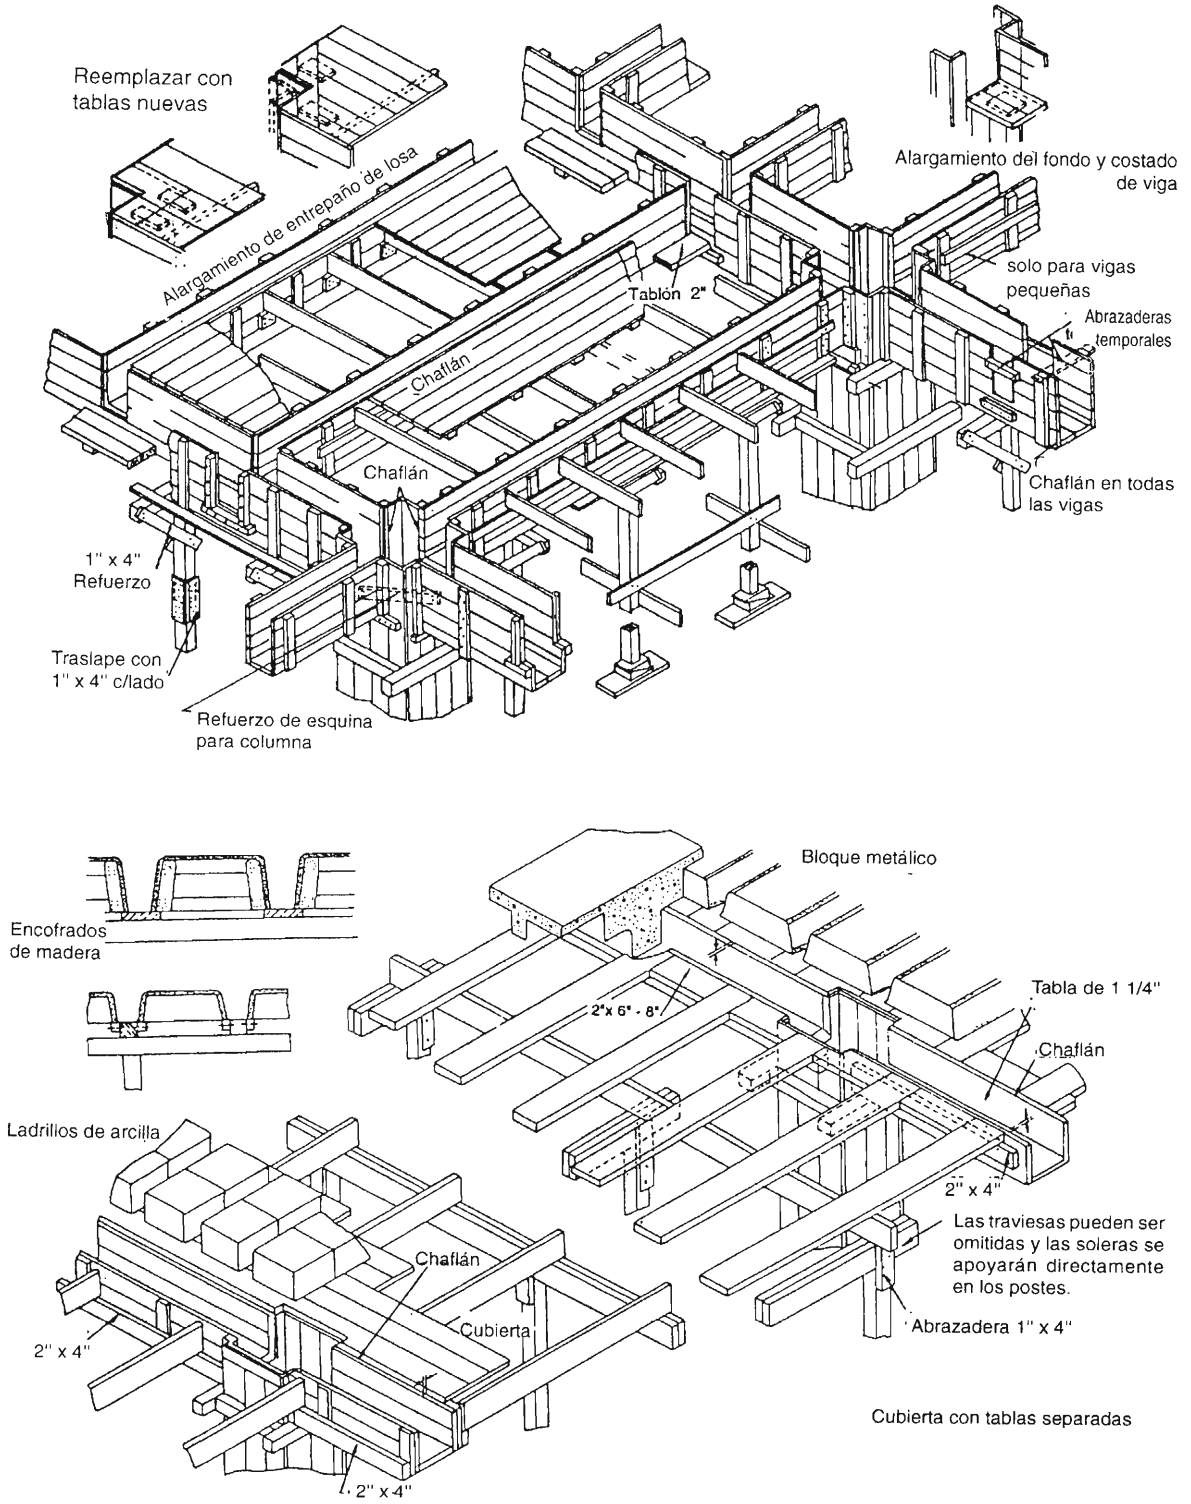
Encofrado de losa aligerada. (Ref. 7)
